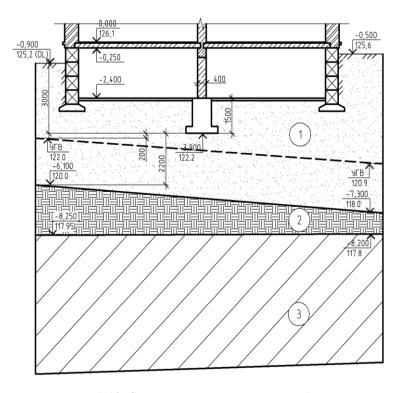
Схема к предварительному выбору ФМЗ под колонну
